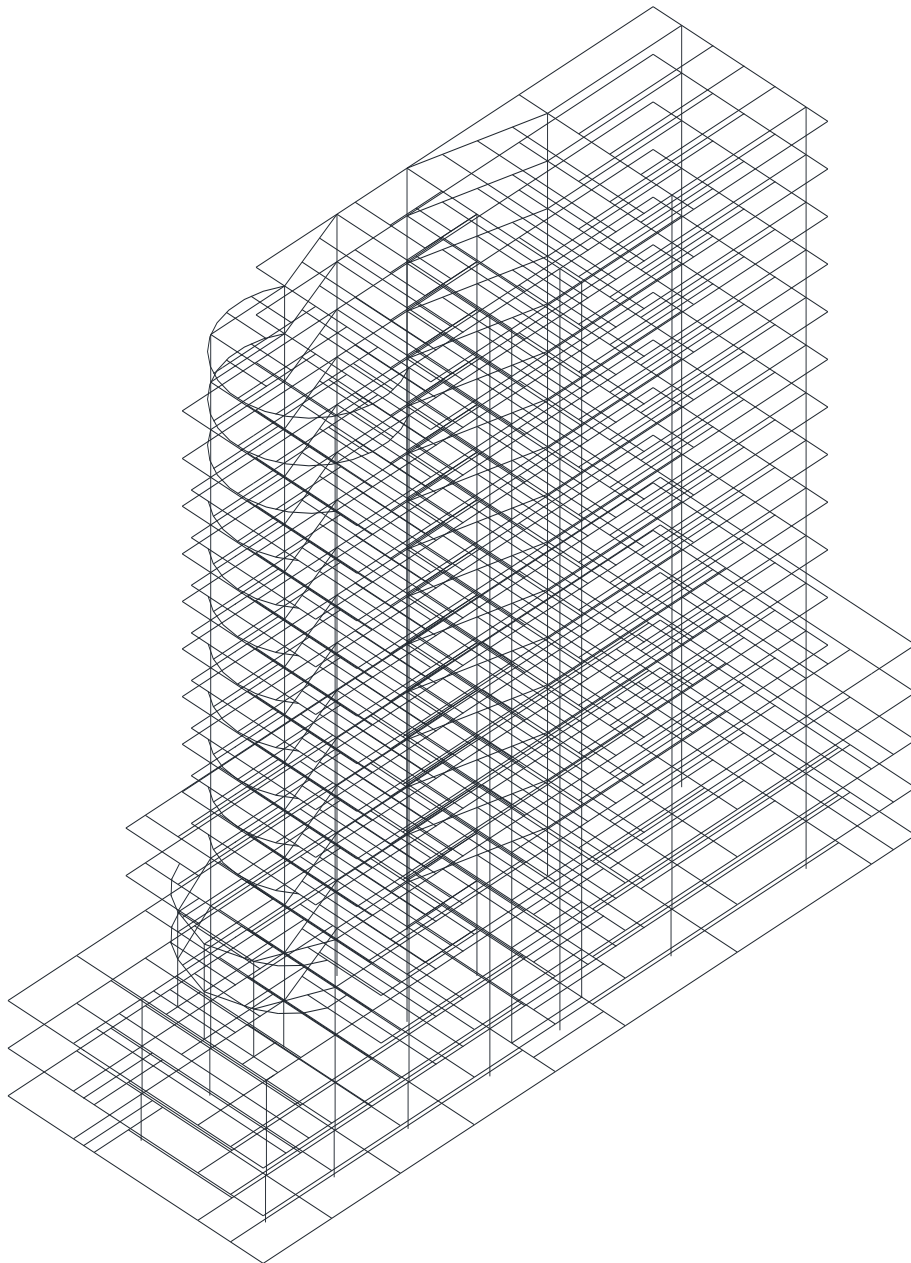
Vista ortogonal del sistema estructural del edificio Ardres Plaza formato AutoCAD
